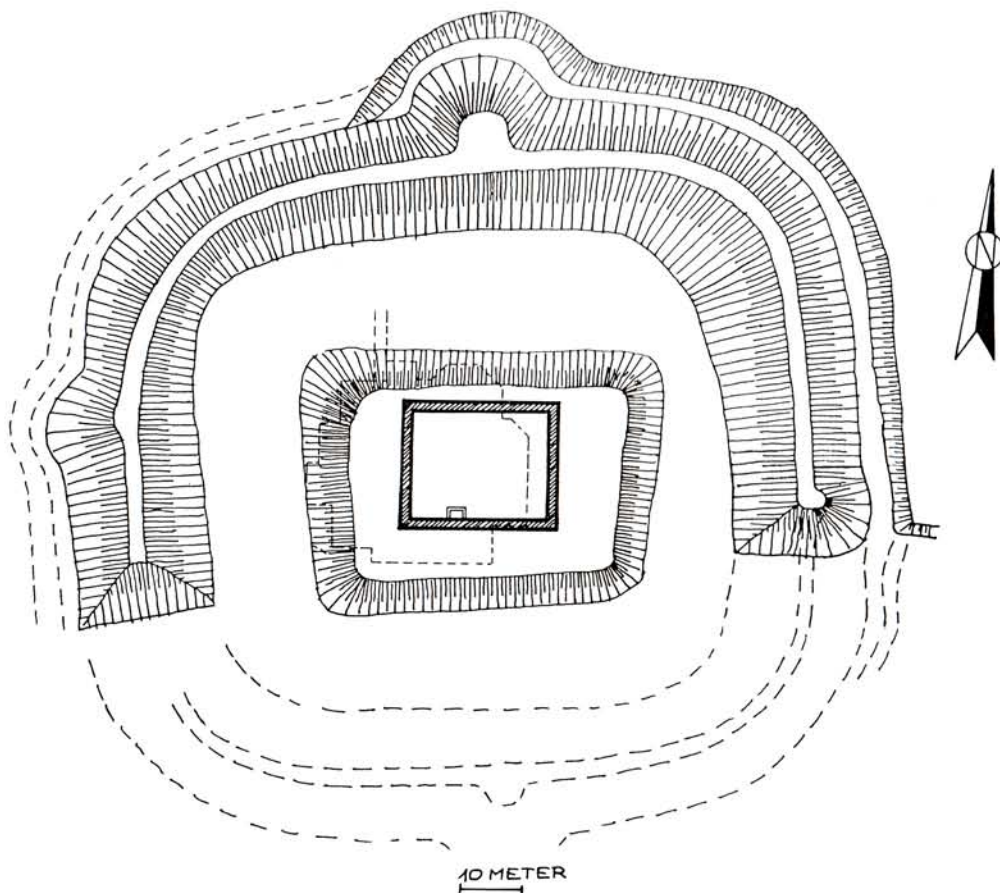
Plandarstellung der Burg Grafendorf mit hypothetischer Rekonstruktion des Südwalls, dem 1975 gefundenen Mauerfundament inklusive Latrinenschacht und dem Grundriss des darauf errichteten „Kolomansheims“
